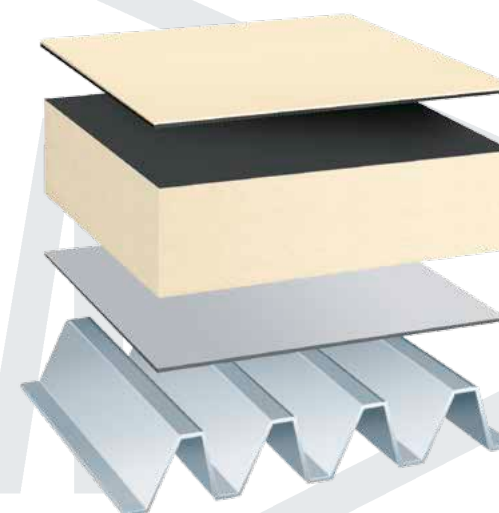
/1: FM-Global geprüfter Dachaufbau: FPO-Kunststoffabdichtung mit BauderTHERMOPLAN, mechanisch befestigt auf Wärmedämmung BauderPIR FA fp und Dampfsperre BauderTEC DFM.
